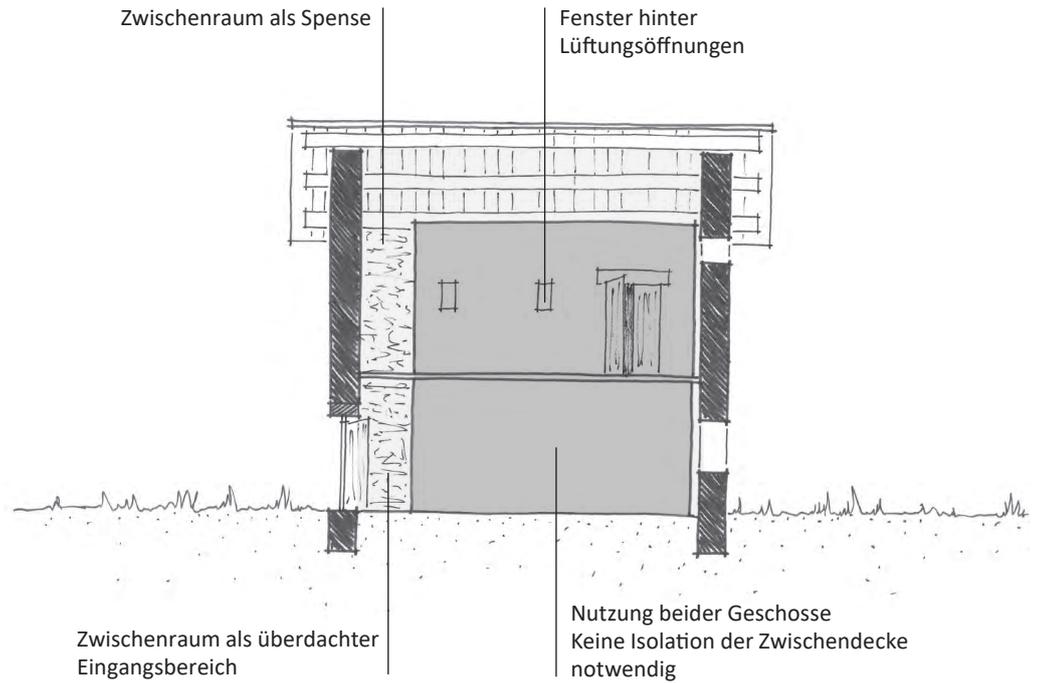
«Haus im Stall»-Prinzip bei steinernen Stallscheunen. Systemdarstellung im Schnitt.
